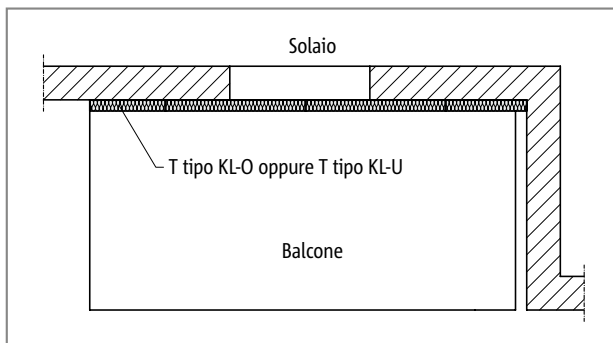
Schöck Isokorb® T tipo KL-O/KL-U: balcone con elementi sporgenti nella facciata
